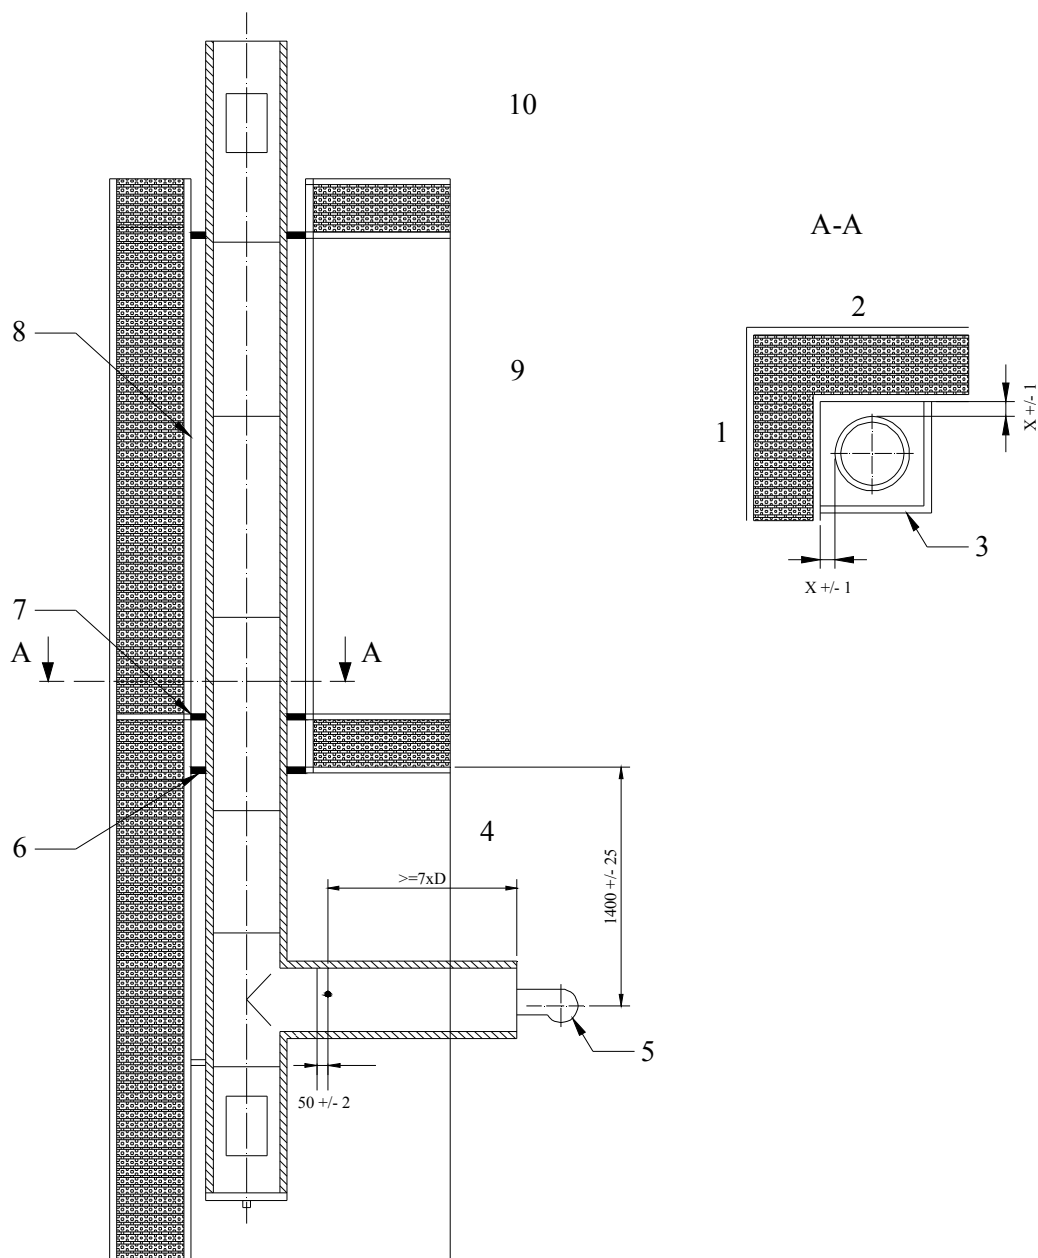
Установка для испытаний на ветровую нагрузку
